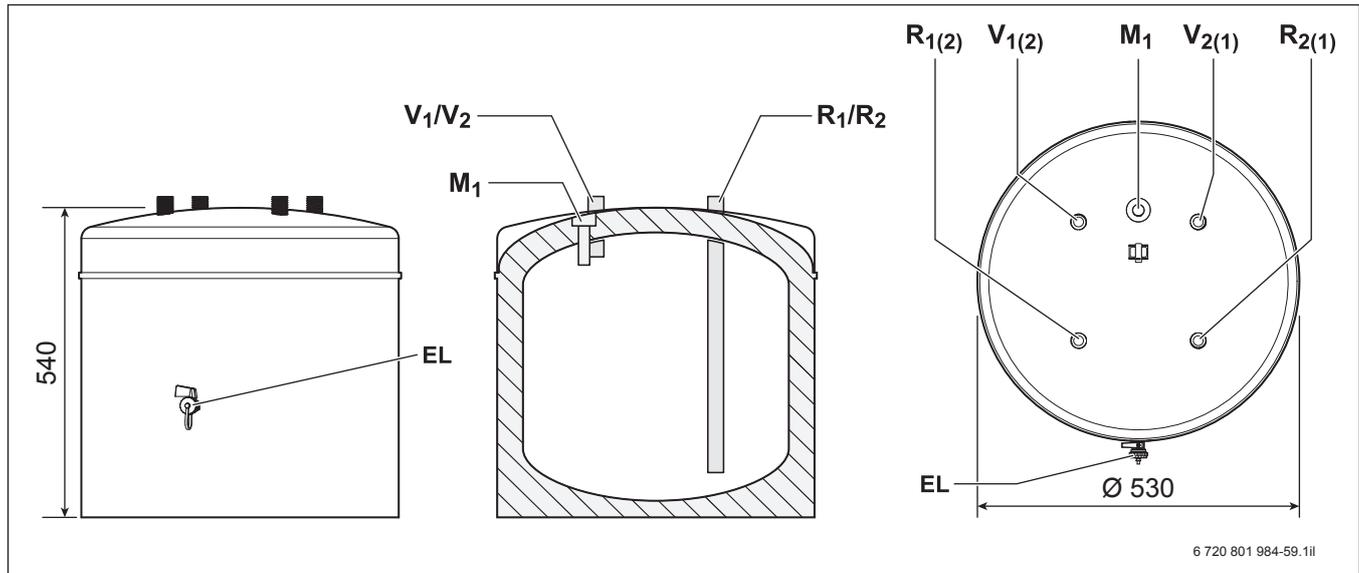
Bau- und Anschlussmaße PSWK 50 (Maße in mm)
